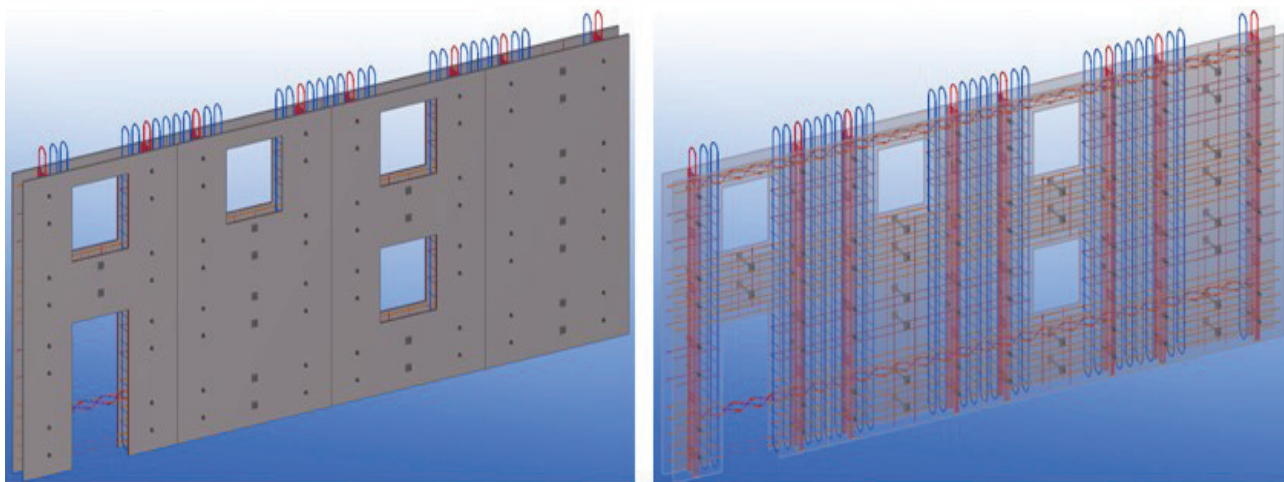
Стеновой армоблок с использованием фибробетонных плит (Размер 11800x4400x400)
